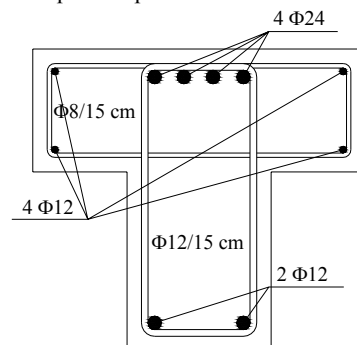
Disposizione delle armature nello sbalzo aggiuntivo
